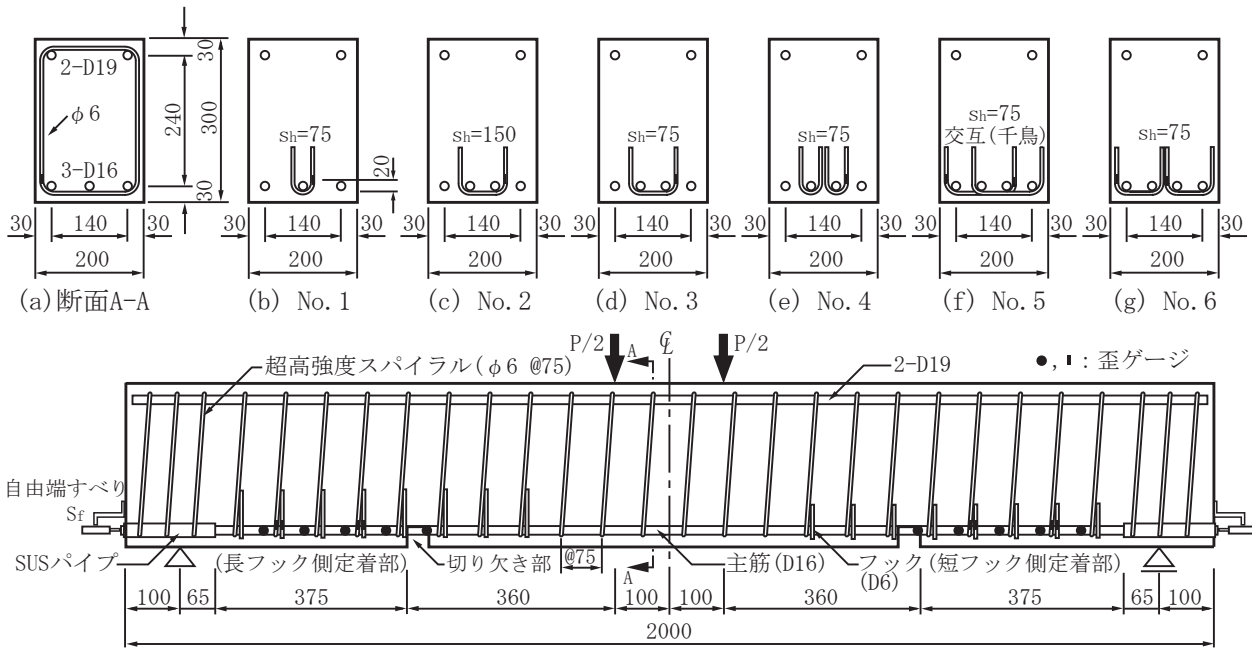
試験体形状・寸法および荷重・測定方法 (単位mm)
